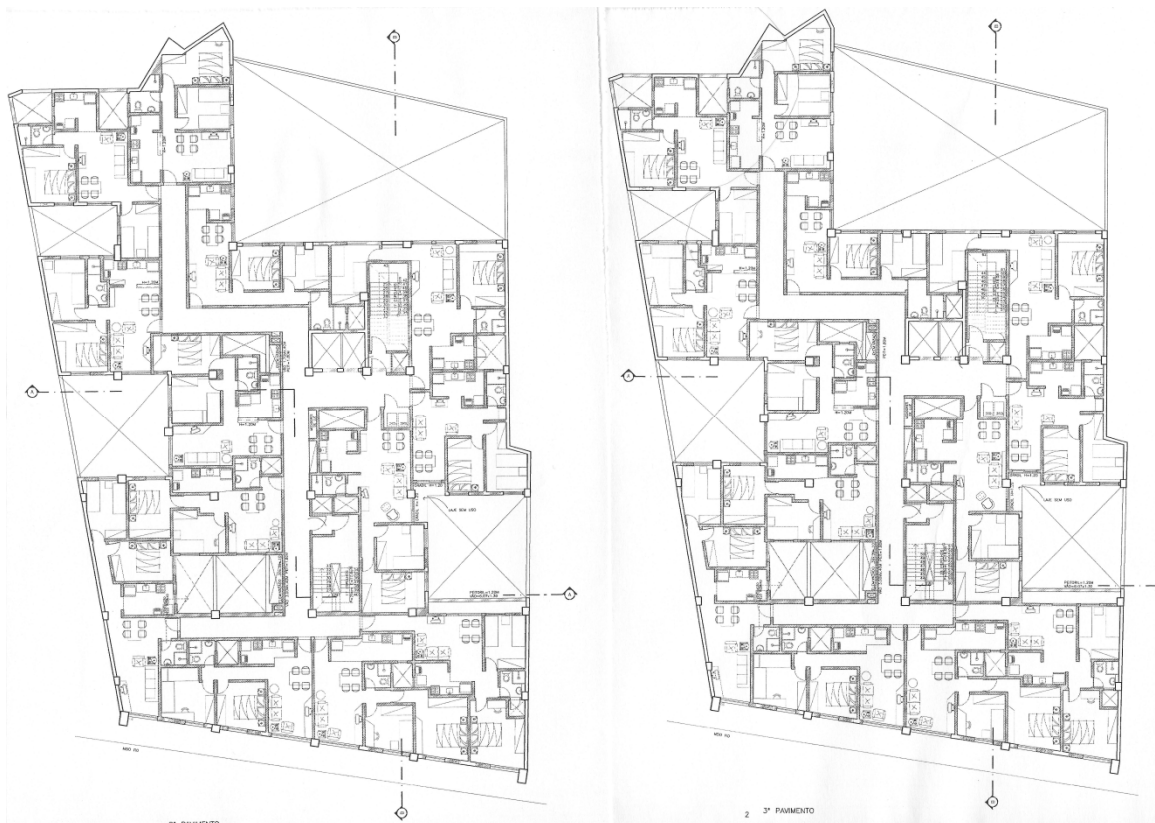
Planta de layout do 2º e 3º pavimento do empreendimento Gamboa 111.
